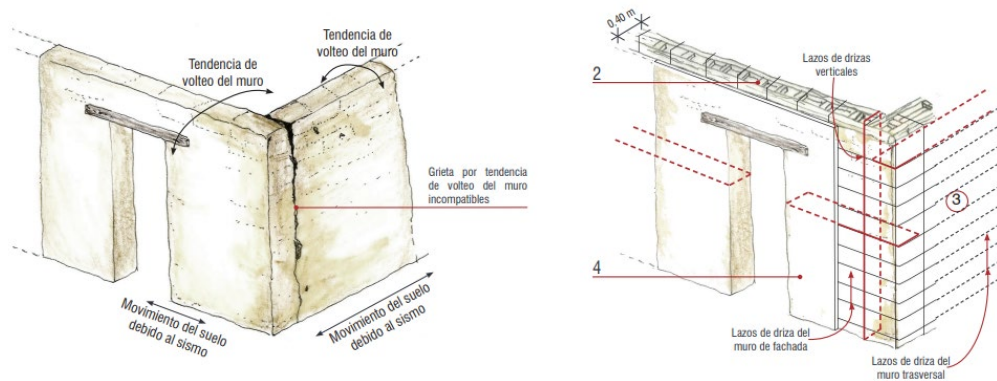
Reforzamiento por grietas verticales en encuentros de muros.
